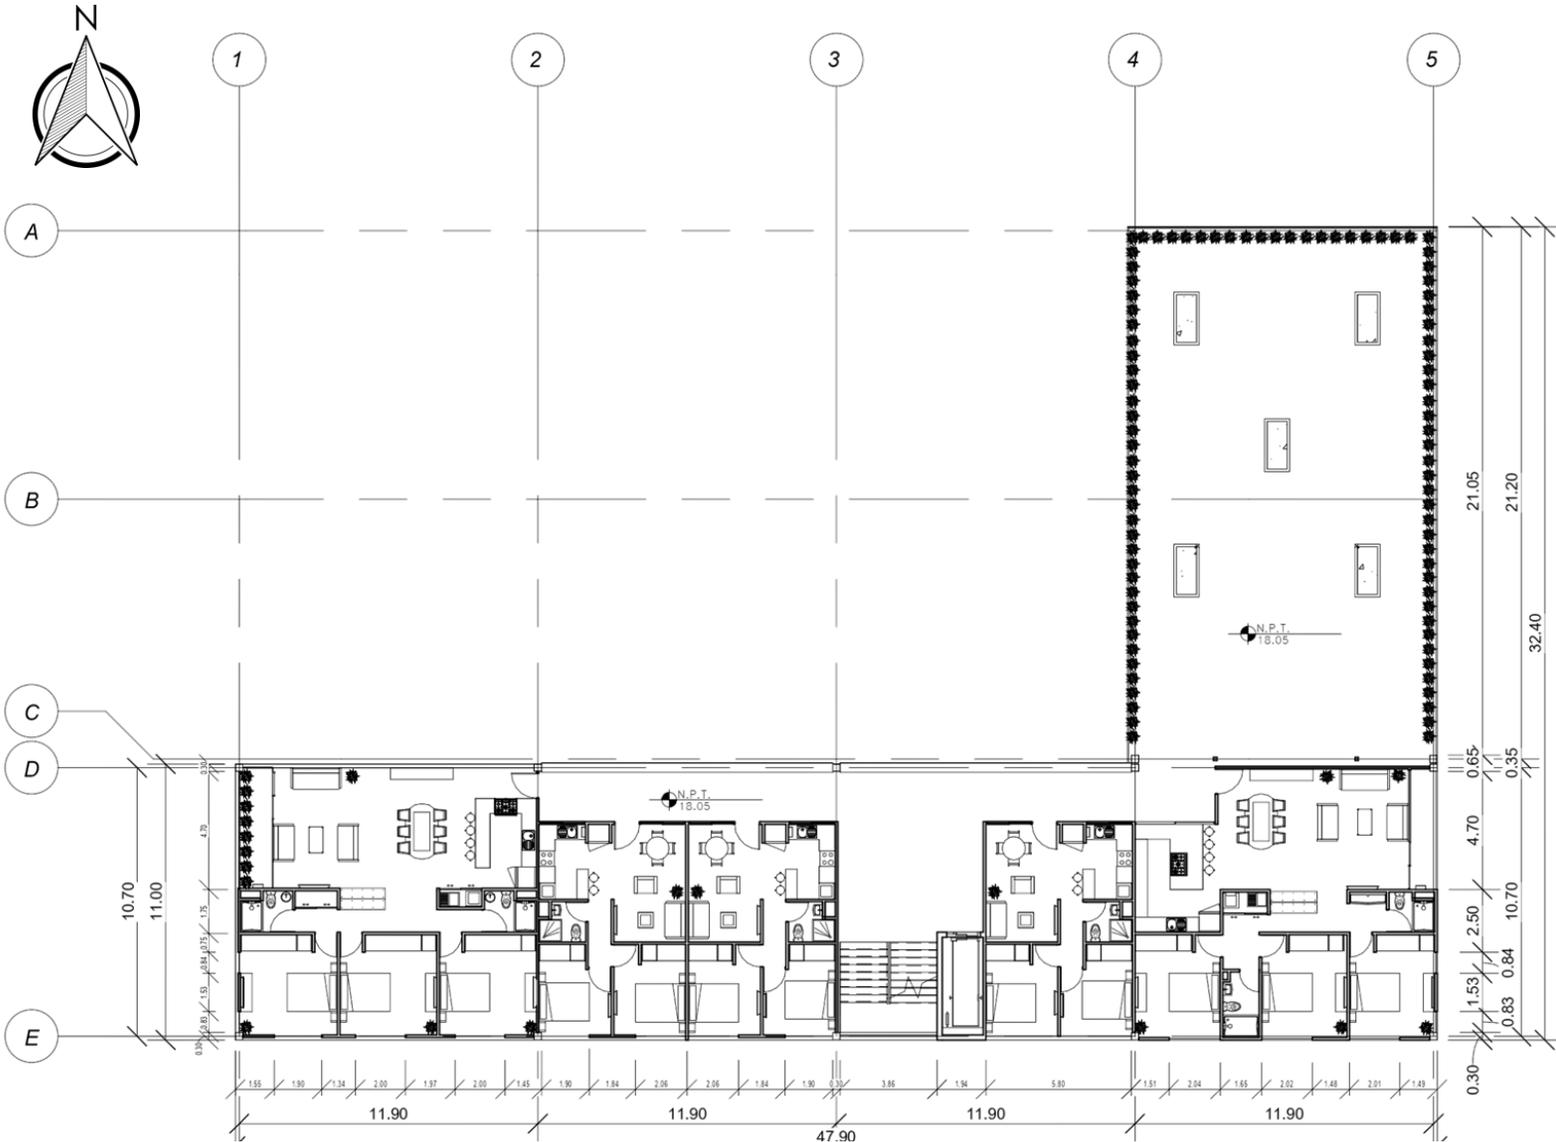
Propuesta final. Planta nivel seis. Elaboración propia. 2022
